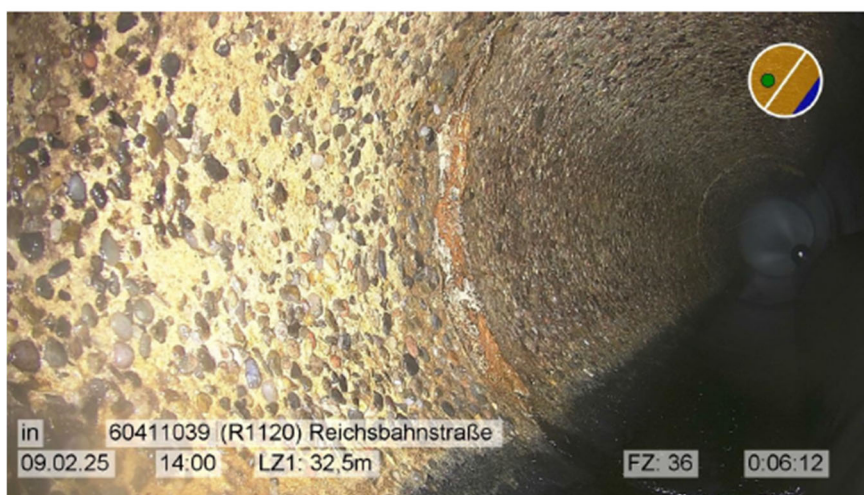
Betonkorrosion (Stat. +32,5 m) in der Haltung 1039 (DN 500)
